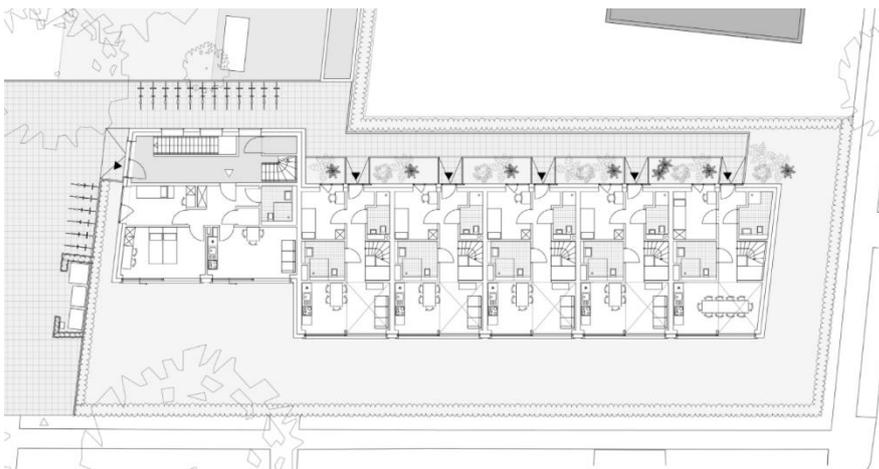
Planta do piso 0 do edifício Henry Korner Hall
